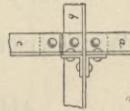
, 185 sind Grundrisse zu 182, 184.
